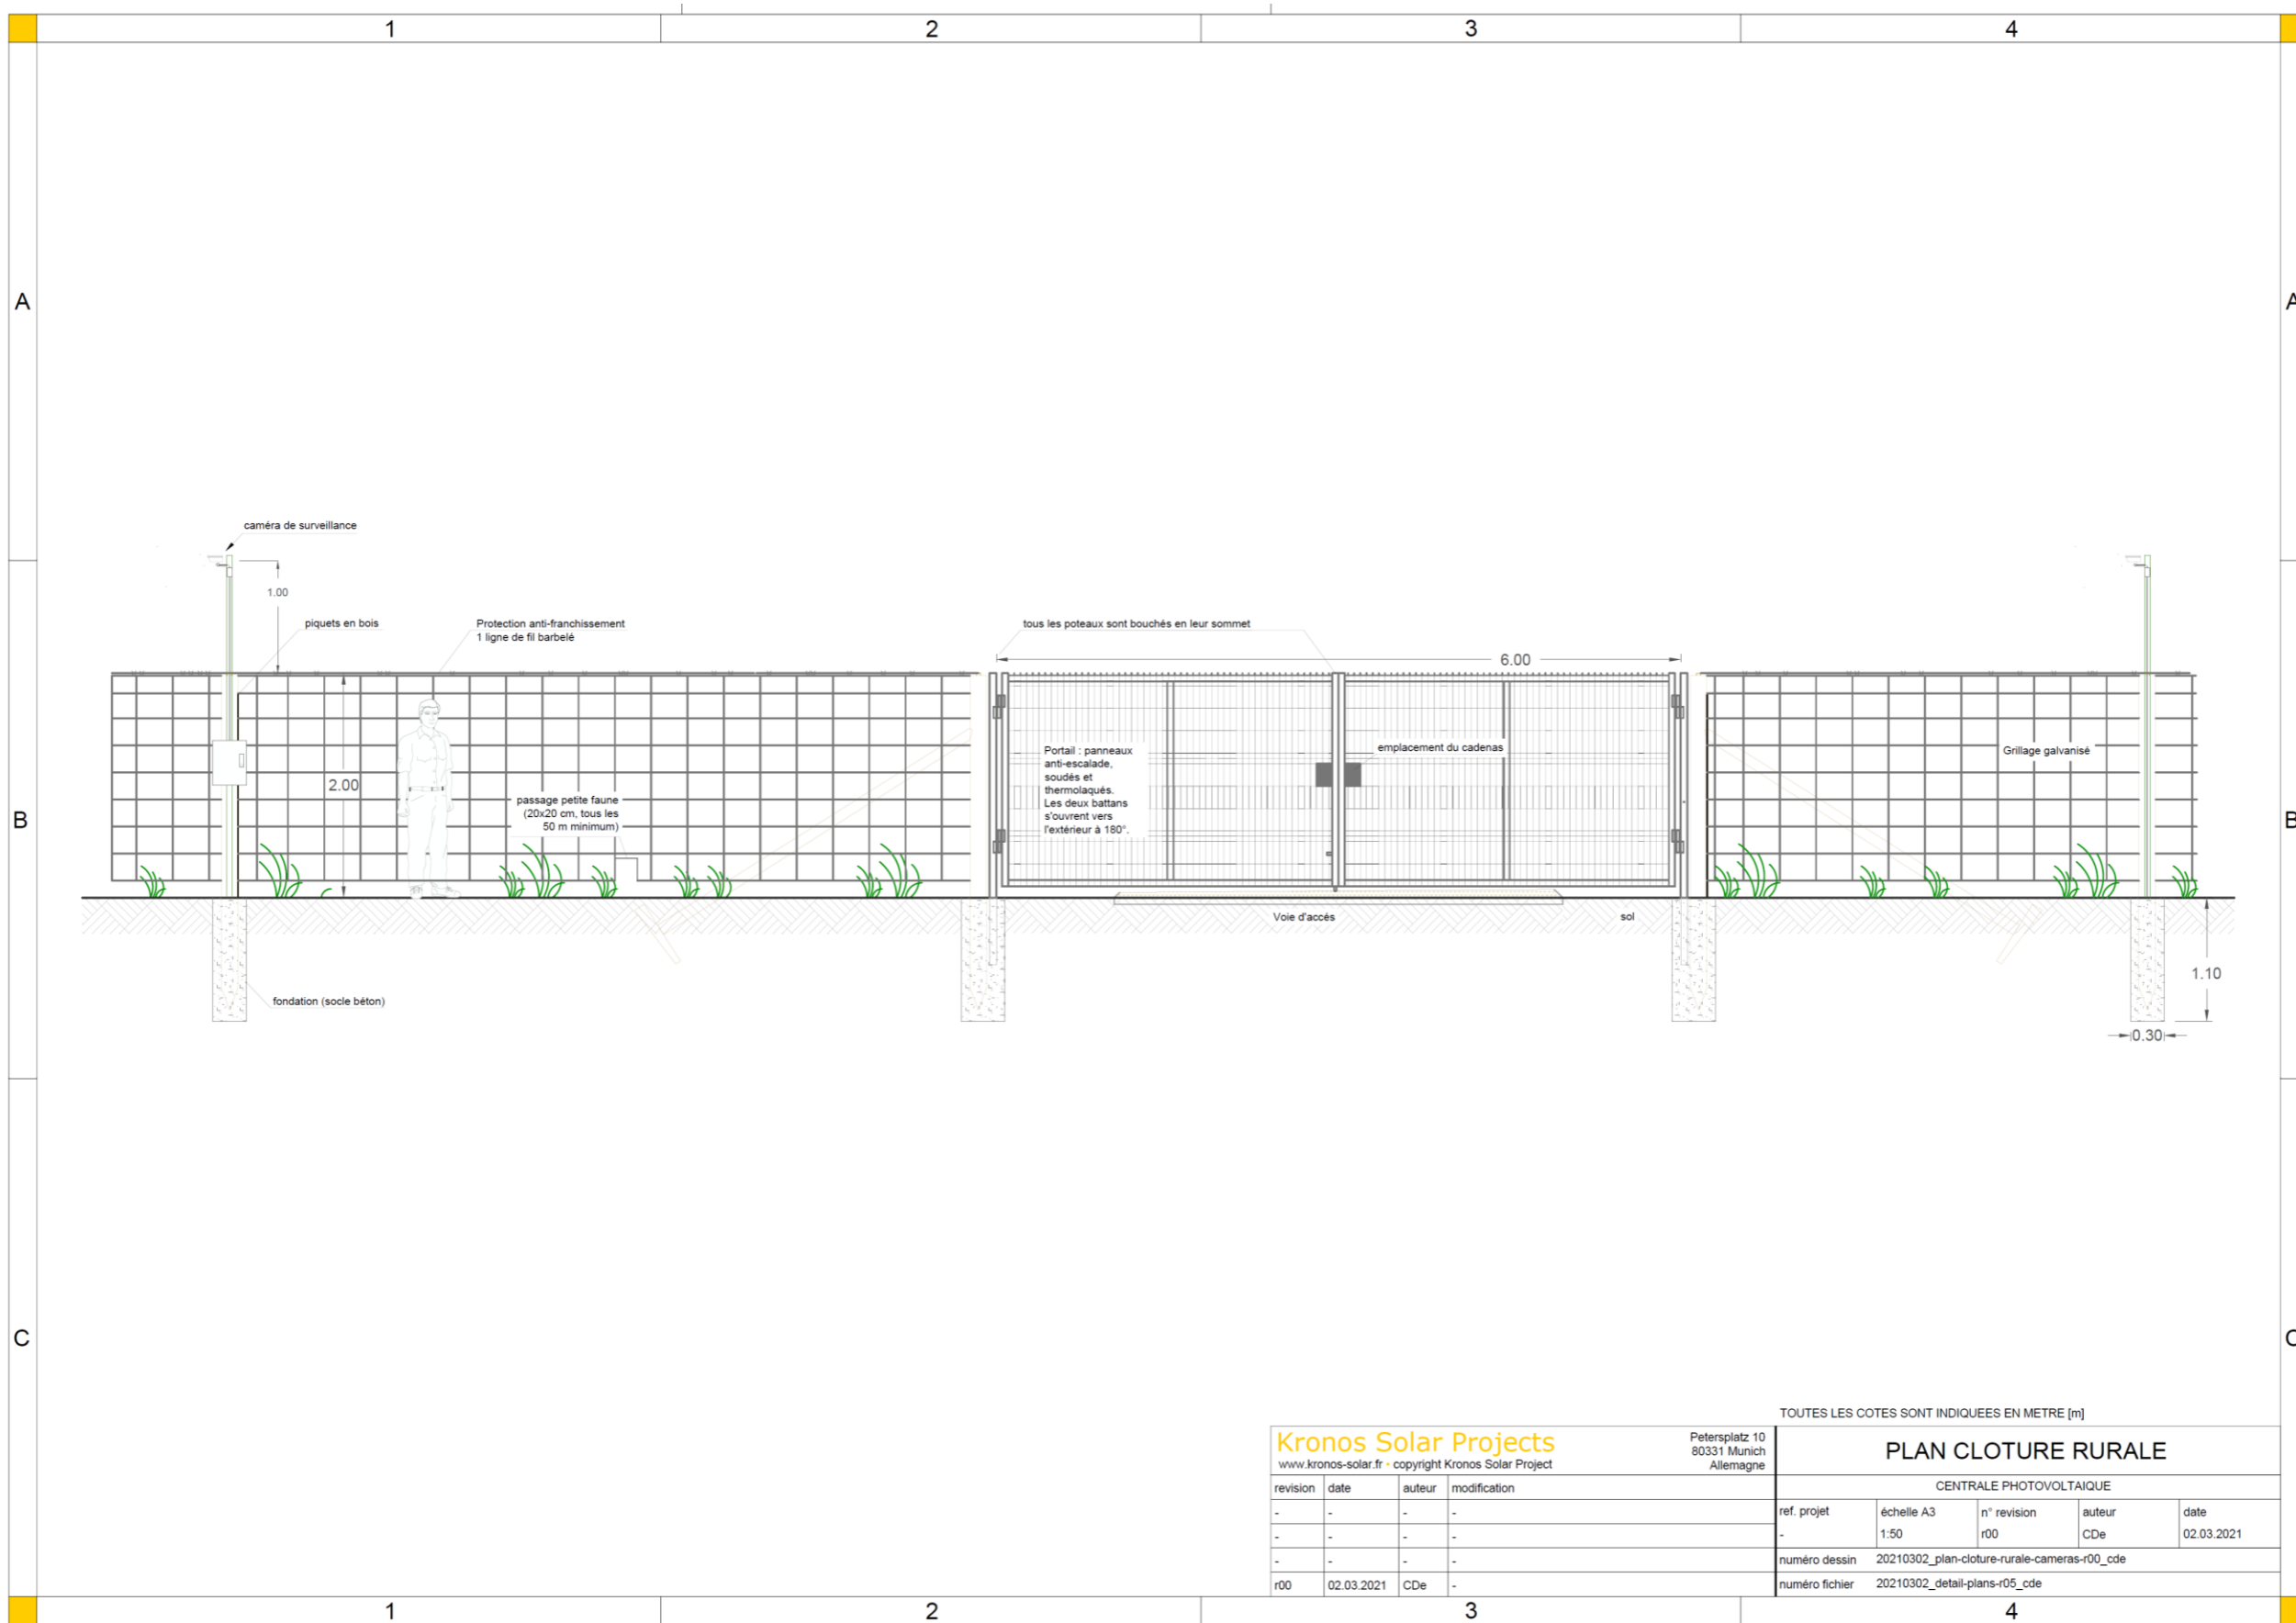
Plan de la clôture rurale située le long du Caminadour – à l'Ouest du parc photovoltaïque (Source : Porteur de projet)
